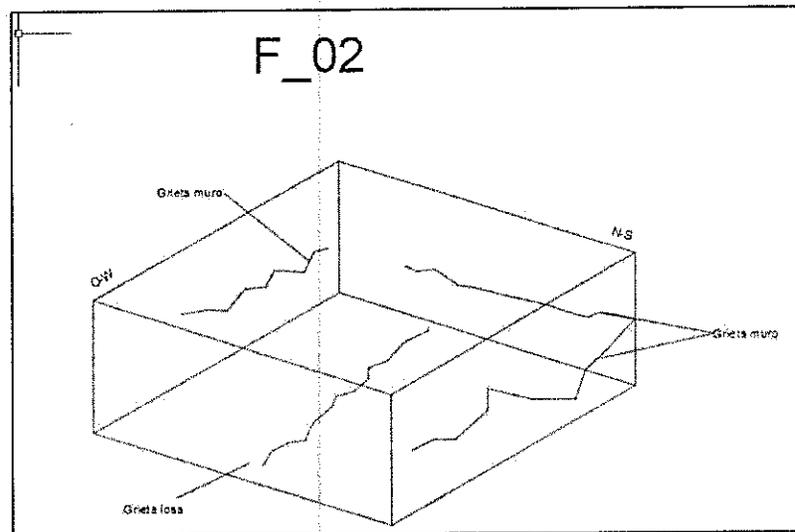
Grietas importantes identificadas en la inspección de campo. "fuente propia"
